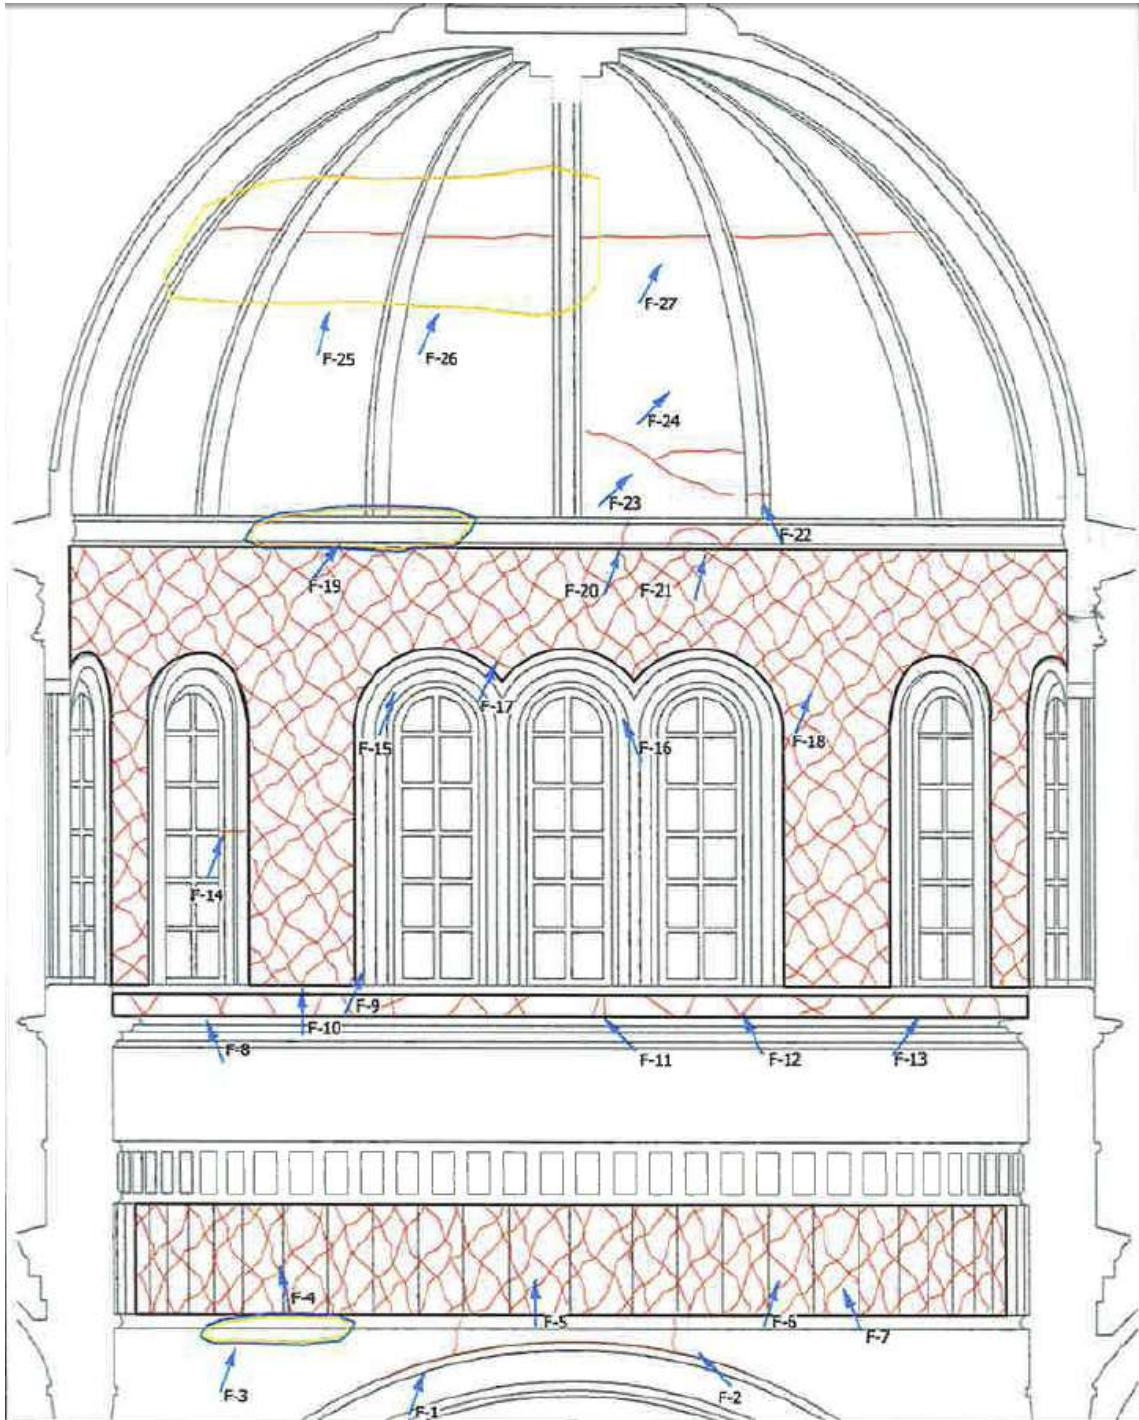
Vista del interior de la cúpula, mirando hacia la calle Bencomo (norte) Principales daños: fisura horizontal a media altura de la cúpula, humedades y desprendimientos de hormigón en cornisas.
